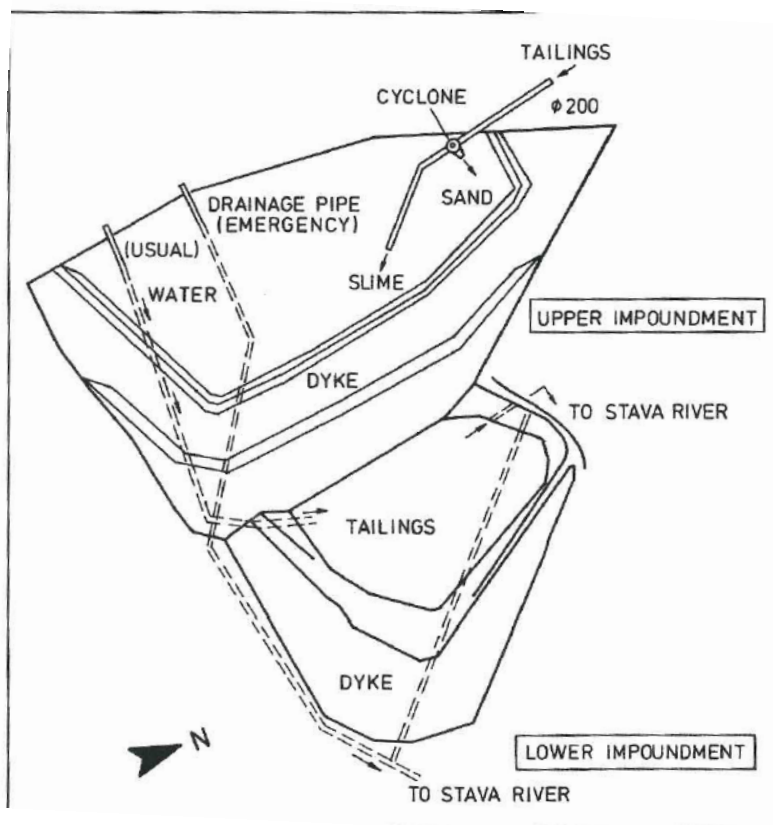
Schema concettuale delle tubazioni di drenaggio delle tailings dam di Stava (Tosatti, 2003)
